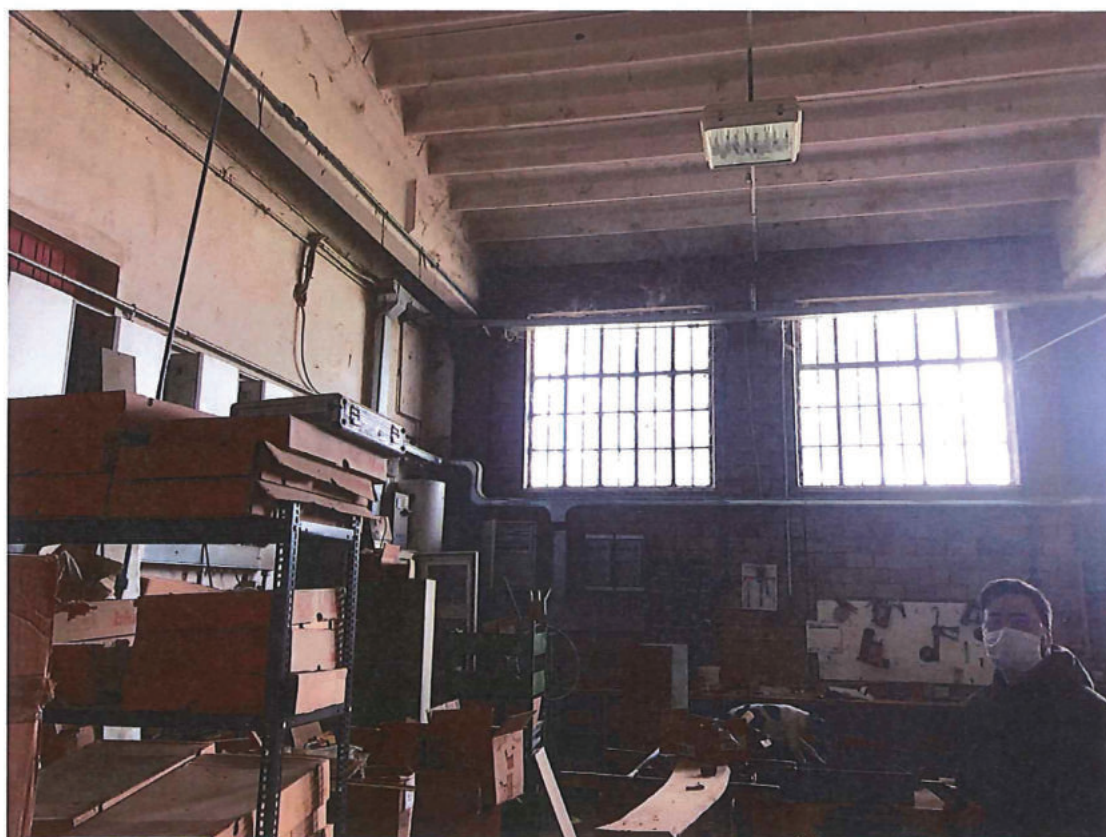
Capannone. La parete di sx è quella della zona uffici.
